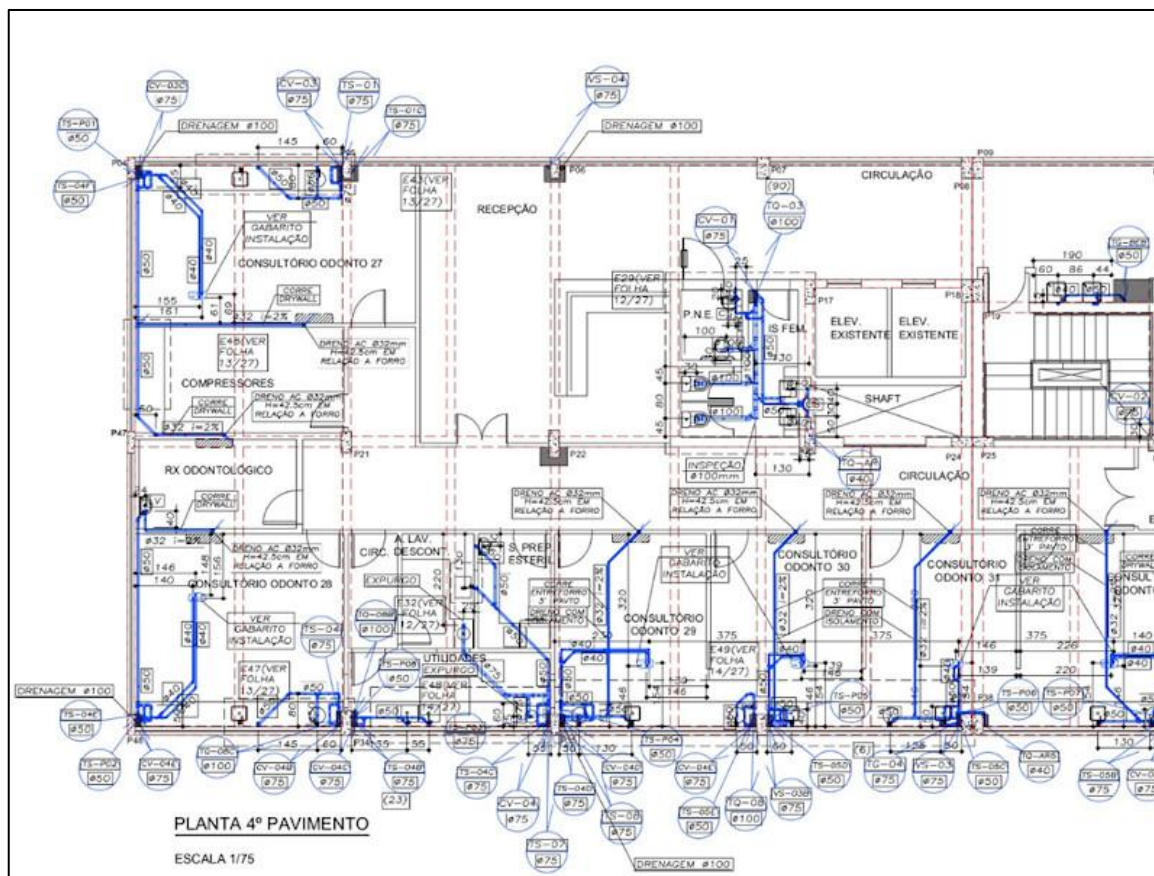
Planta 4º pavimento – redes de tubulações separadas e shafts pilares.
